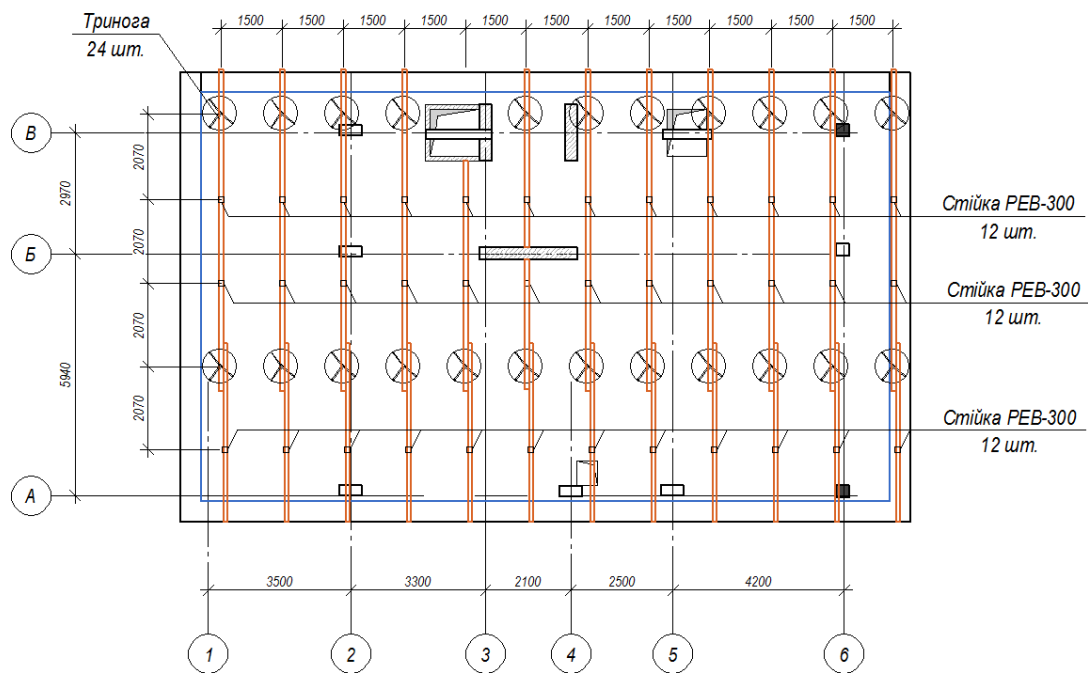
Схема розкладання елементів опалубки на рівні балок нижнього ярусу на другій захватці
